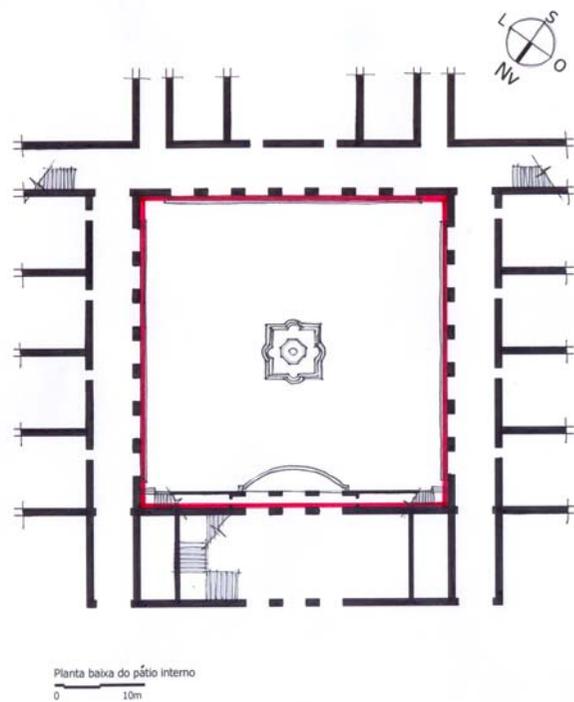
Estudo de proporção do pátio interno do ISERJ, planta baixa (Fonte: O AUTOR,2006).
